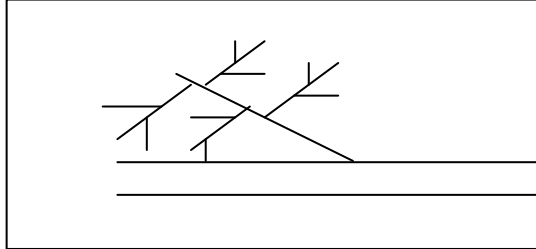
Schéma à Collecteur Transversal ou Oblique
